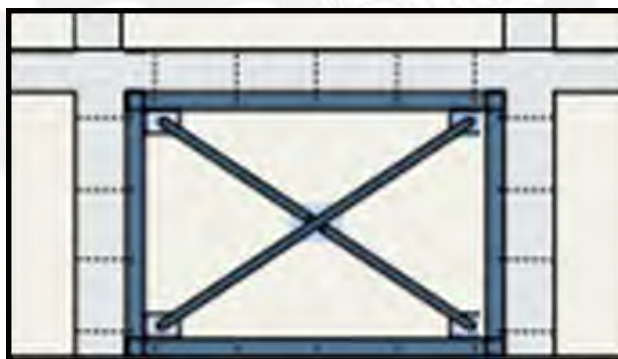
Reforzamiento con diagonales y marco de acero a una estructura existente de concreto armado
